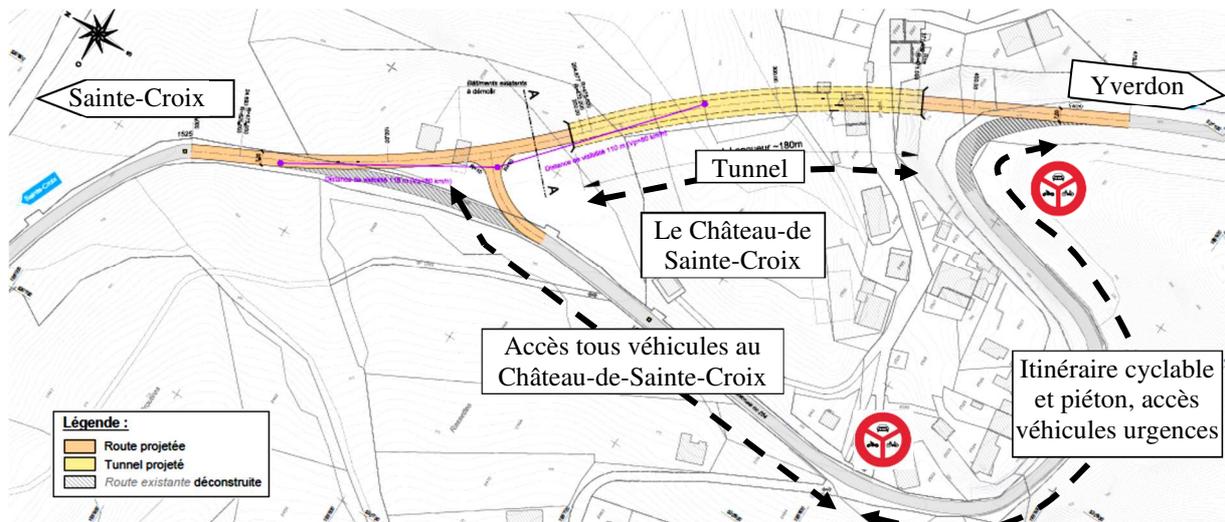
Situation du projet de tunnel passant sous Le Château-de-Sainte-Croix
